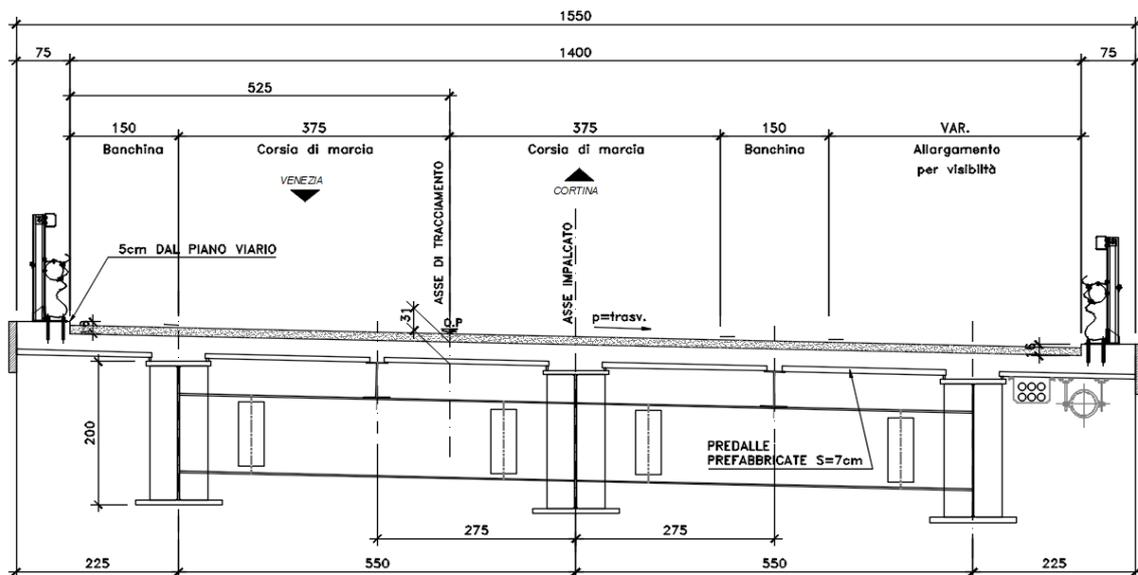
Sezione trasversale impalcato tra pila P2 e spalla SPB
